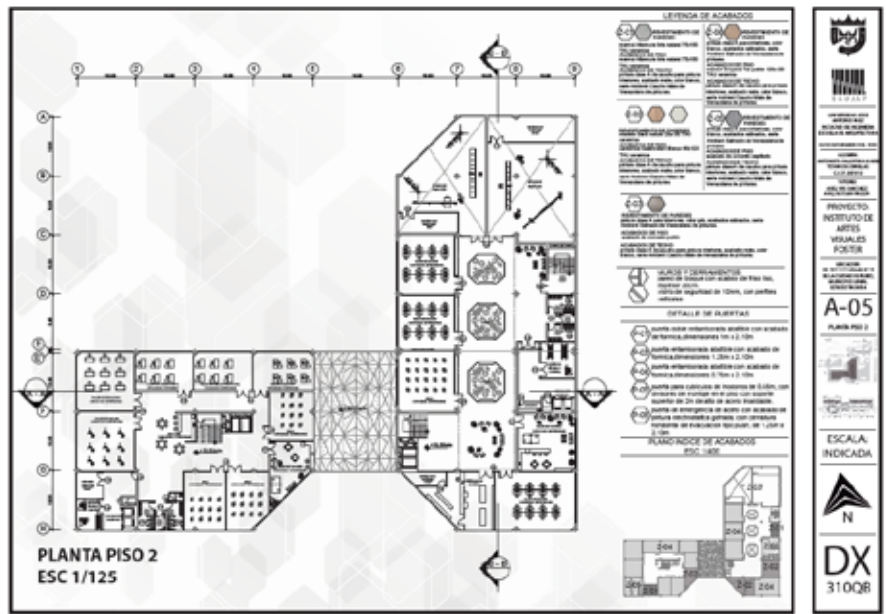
Plano de Planta Nivel 2. La autora (2020)
